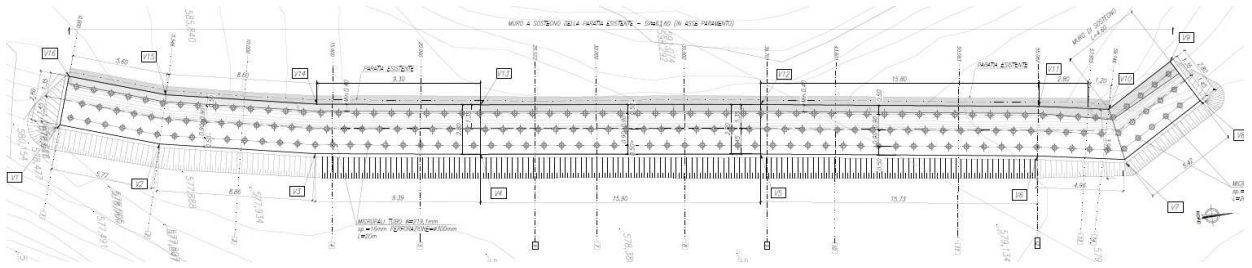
Stralcio planimetrico muro di consolidamento della berlinese esistente.
